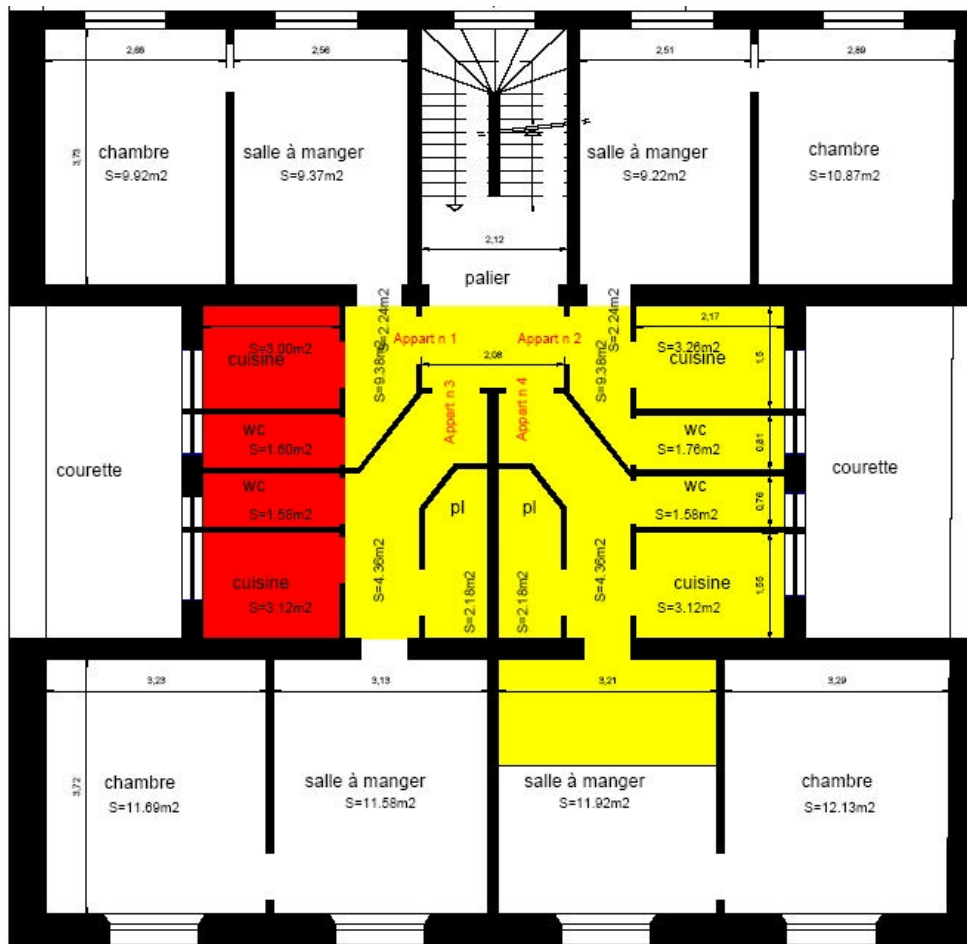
Plan du site d'étude 2^{ème} étage - 181, avenue Jean Jaurès Paris 19
